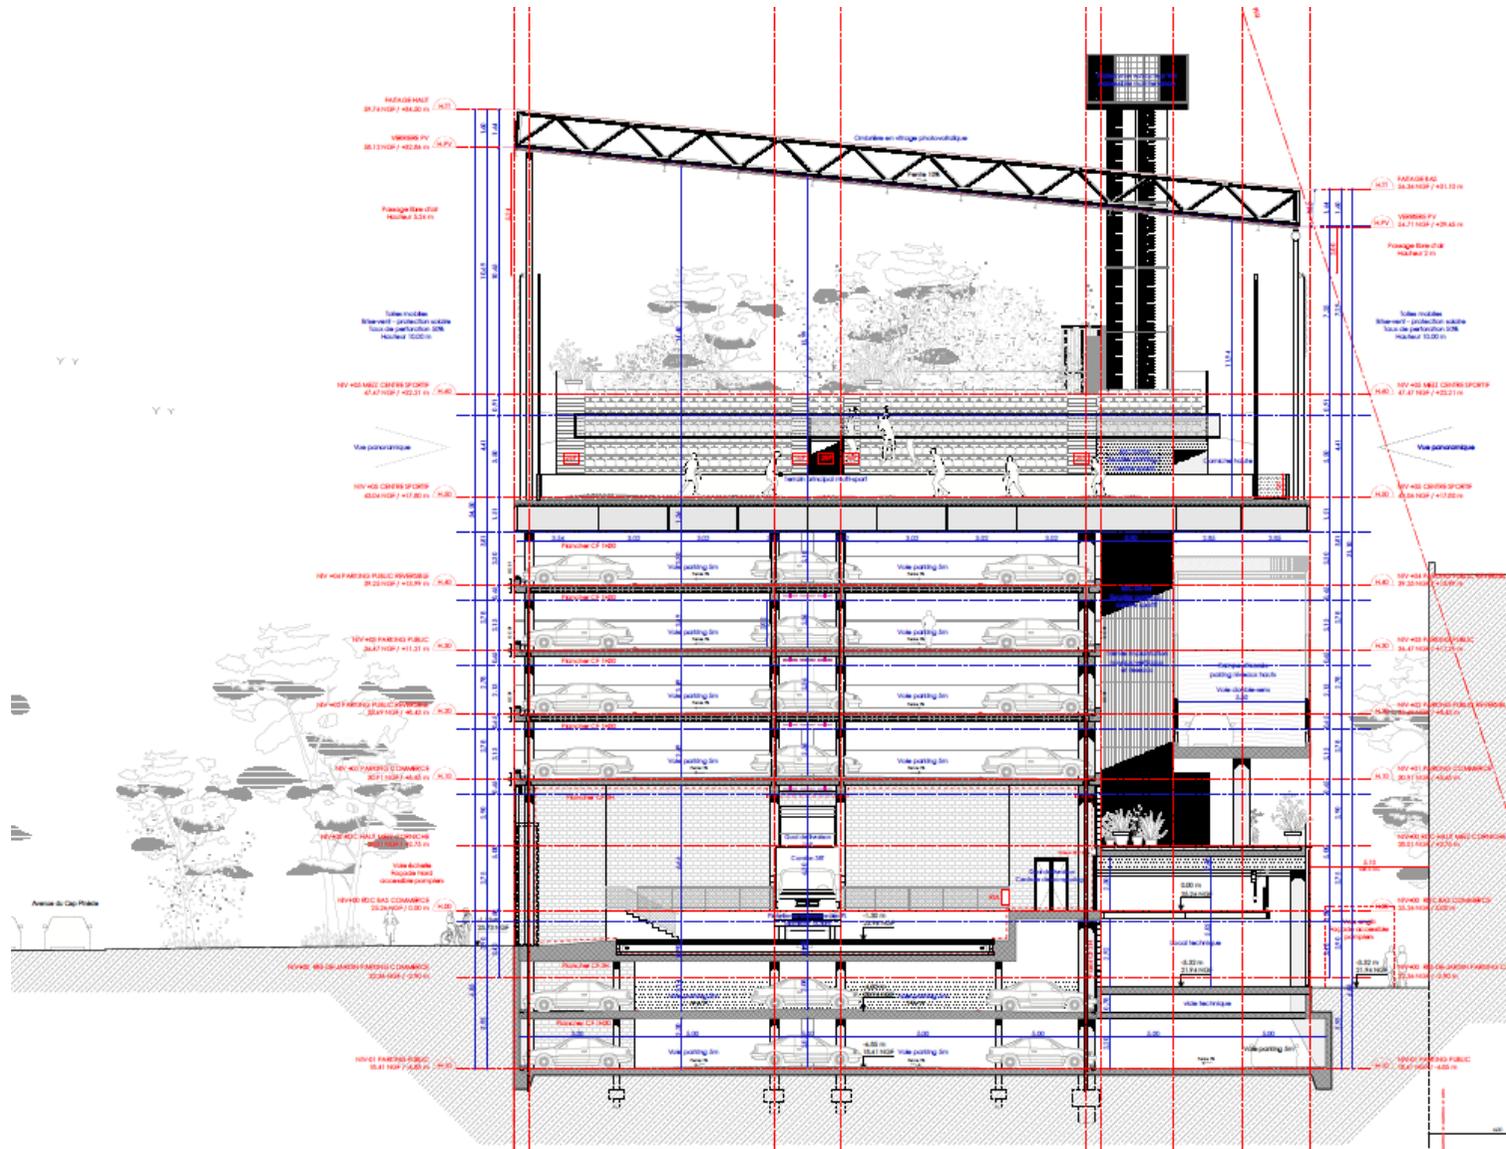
Coupe transversale Nord-Sud du bâtiment projeté, au niveau de l'aire de livraison
